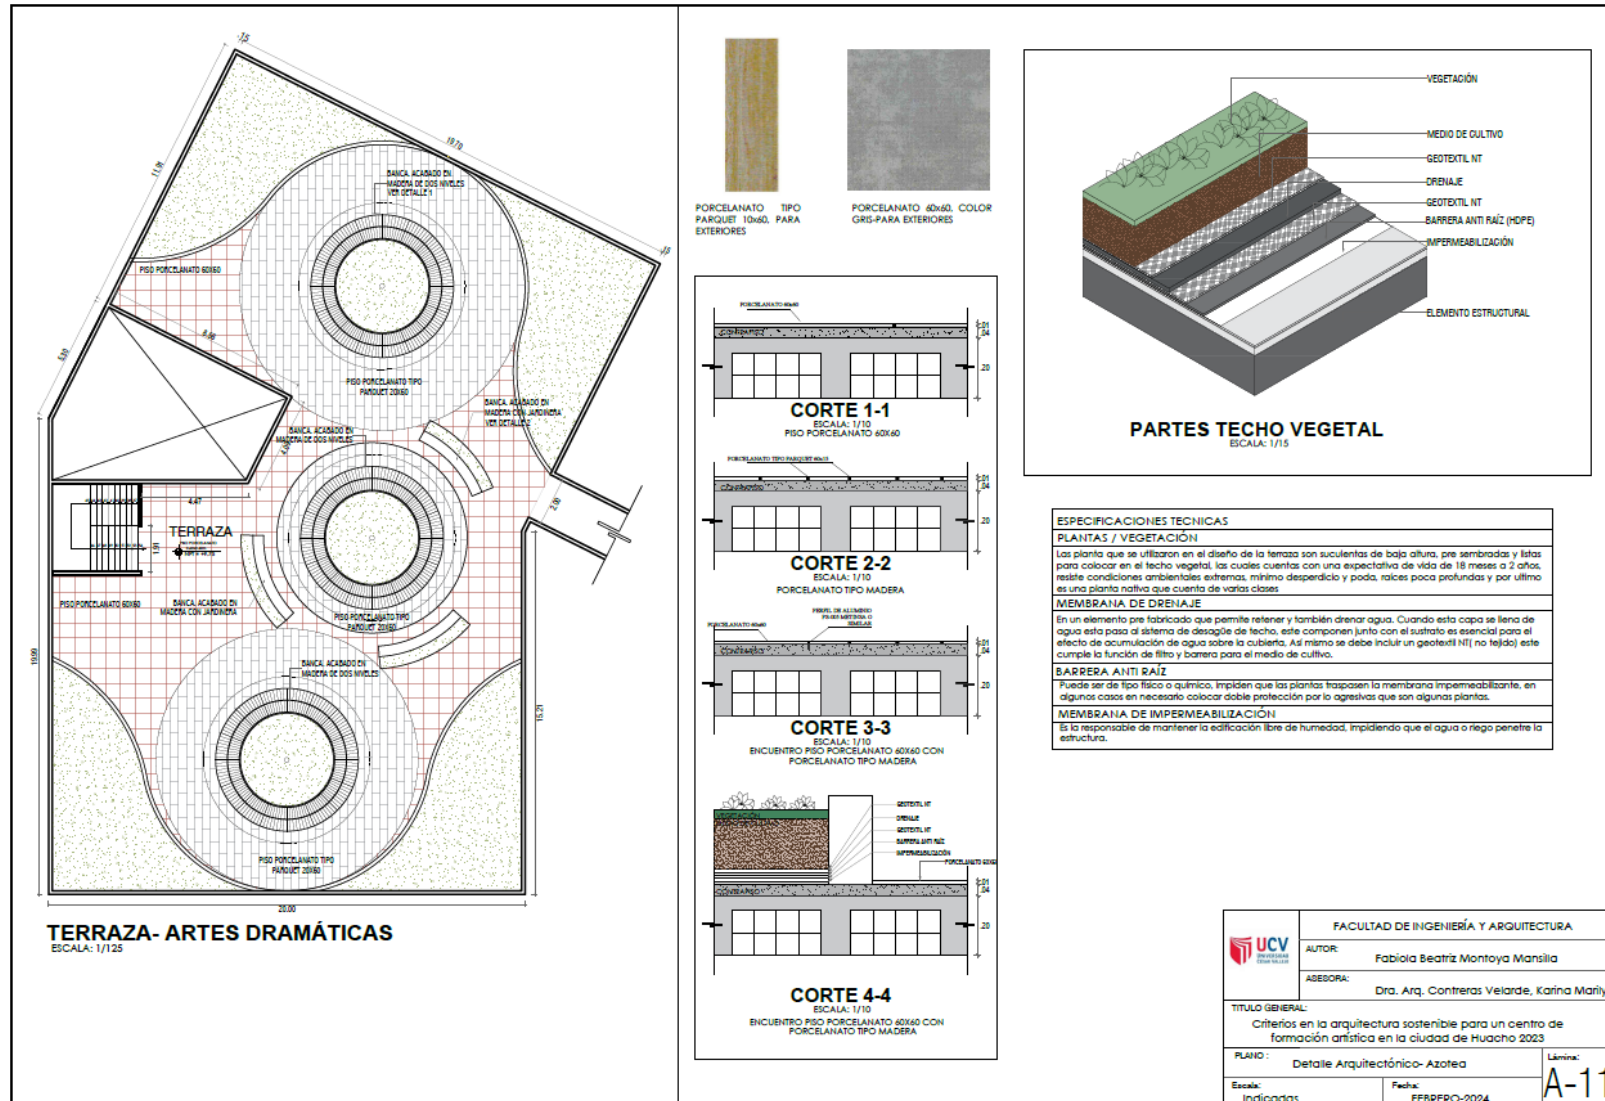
Plano de Detalles Arquitectónicos 2, Azotea de Escuela de Arte Dramático
